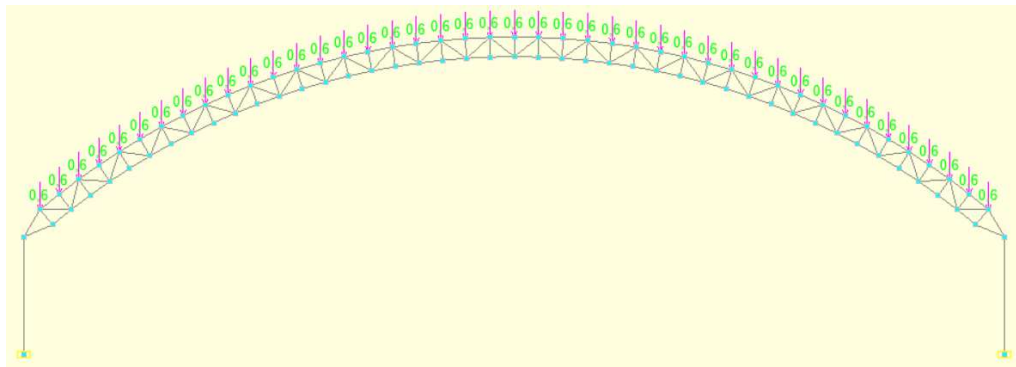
Постоянная нагрузка от веса кровли
